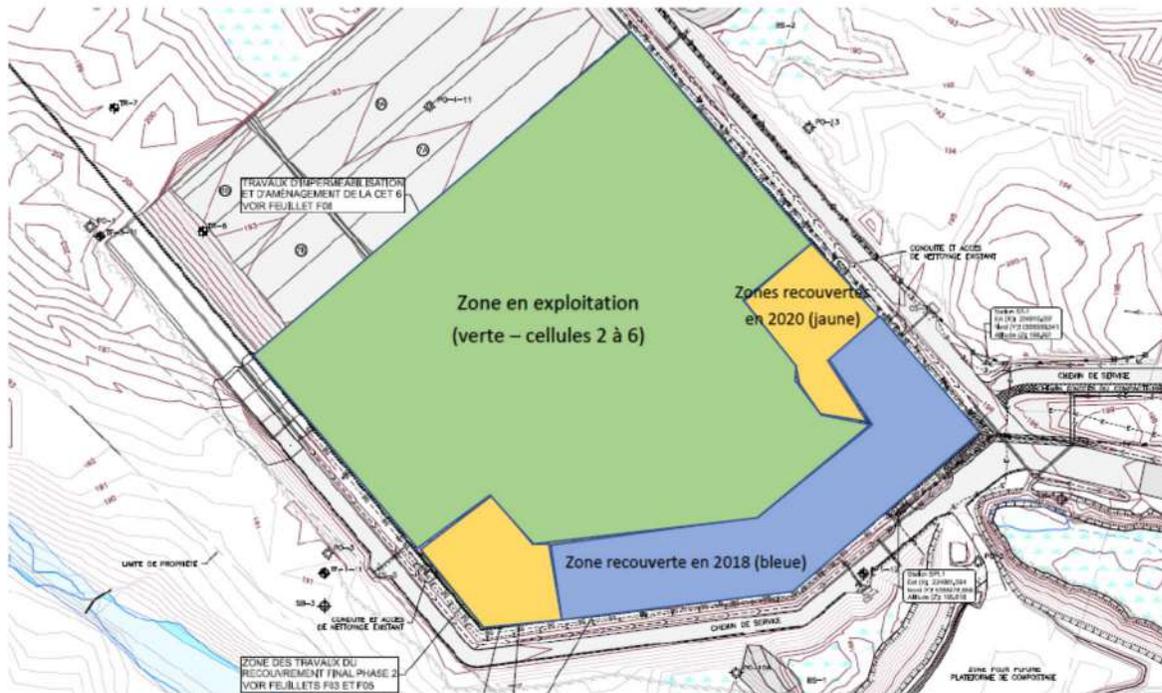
Plan d'aménagement des cellules actuelles d'Hébertville-Station
